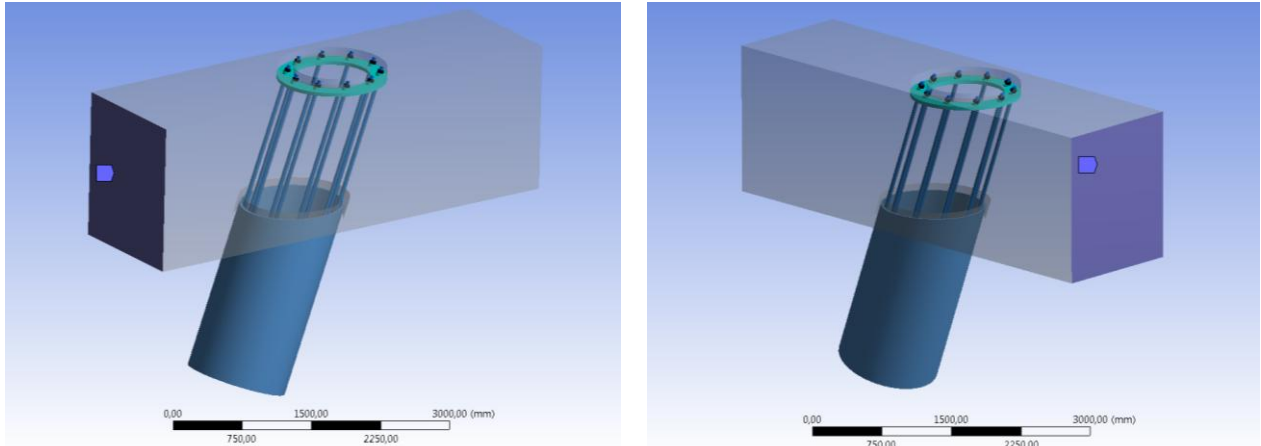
Apoyos fijos en extremos de viga de la conexión con pilote inclinado.
